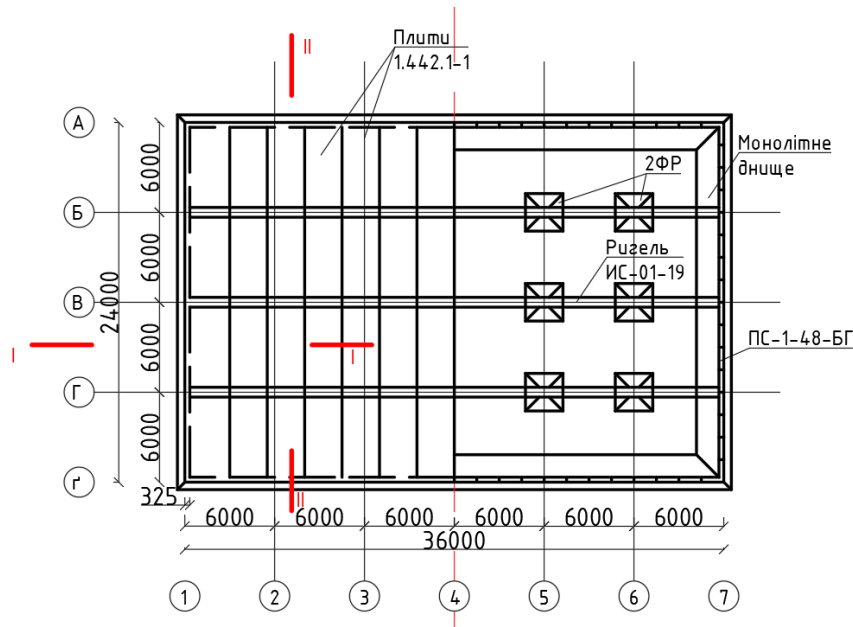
Схематичний план резервуару чистої води місткістю 4 000 м<sup>3</sup> з маркуванням конструкцій каркаса
